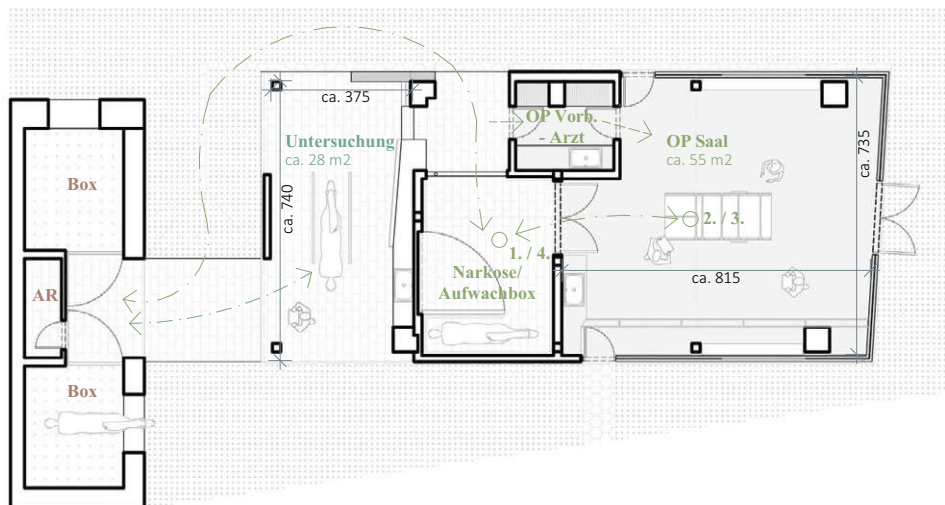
Grundriss Equine Clinic (Quito)
